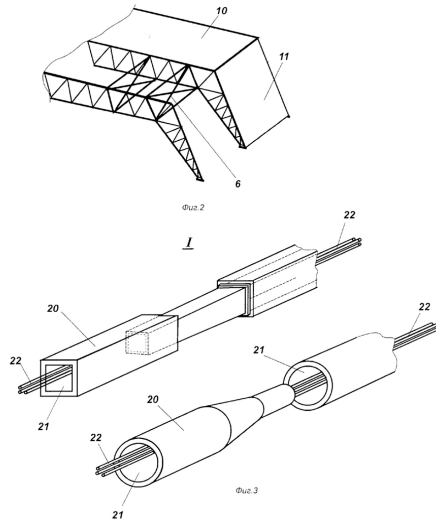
Фиг. 2 – соединение ферм покрытия между собой поперечной несущей конструкцией; фиг. 3 – узел I на рис. 1 – подвижный узел нижнего пояса фермы, выполненный в виде прямоугольного или круглого сечения [4], где: 6 – поперечная несущая конструкция; 10 – крыша ангара; 11 – несущие стены ангара; 20 – подвижные элементы нижнего пояса; 21 – пустоты; 22 – несущие канаты.
